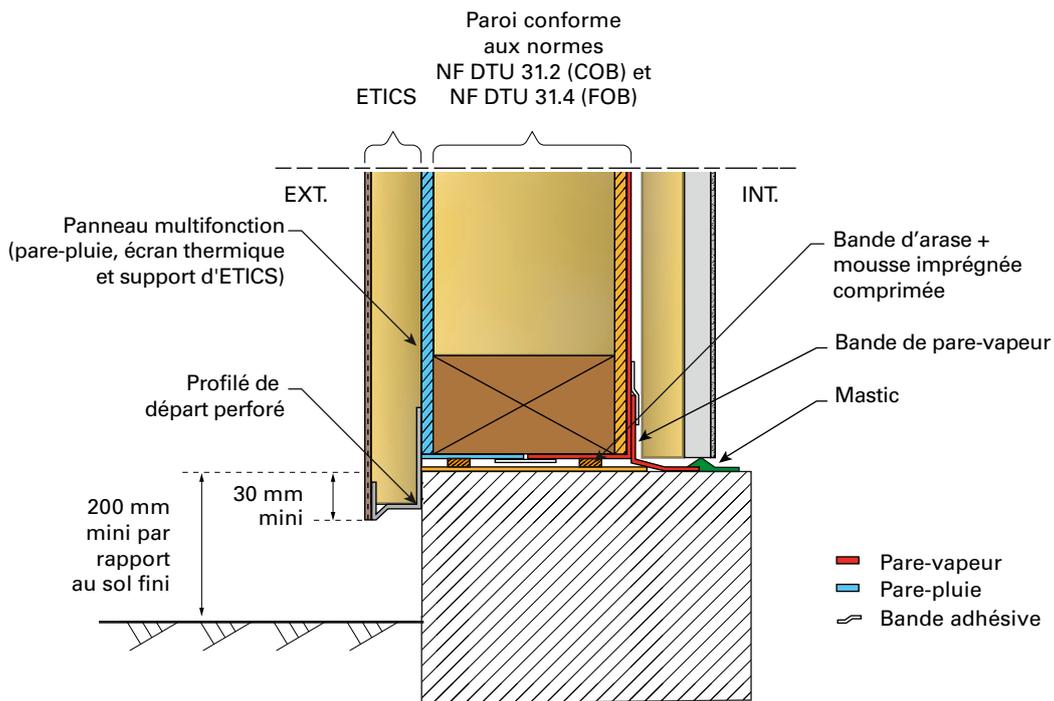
Exemple de pied de façade avec un panneau rigide ayant la fonction pare-pluie
